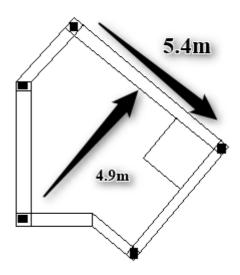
Dalle pleine avec ouverture pour ascenseur
